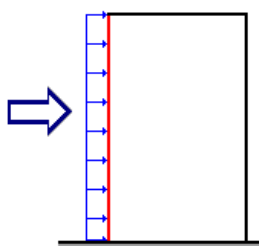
Расчетная схема определения ветровой нагрузки на наветренную поверхность.
